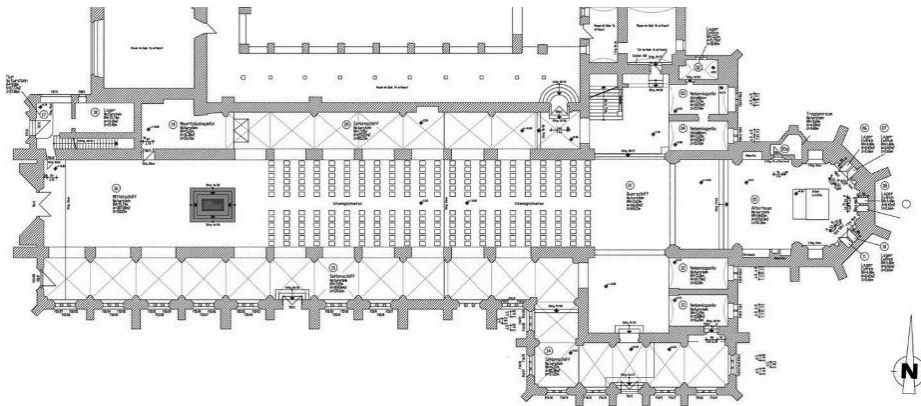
Grundrissplan des Erdgeschosses der Klosterkirche St. Marien in Schulpforte im Maßstab 1:100. Die Tumba befindet sich im ersten Joch des Mittelschiffes im Westteil der Kirche.
